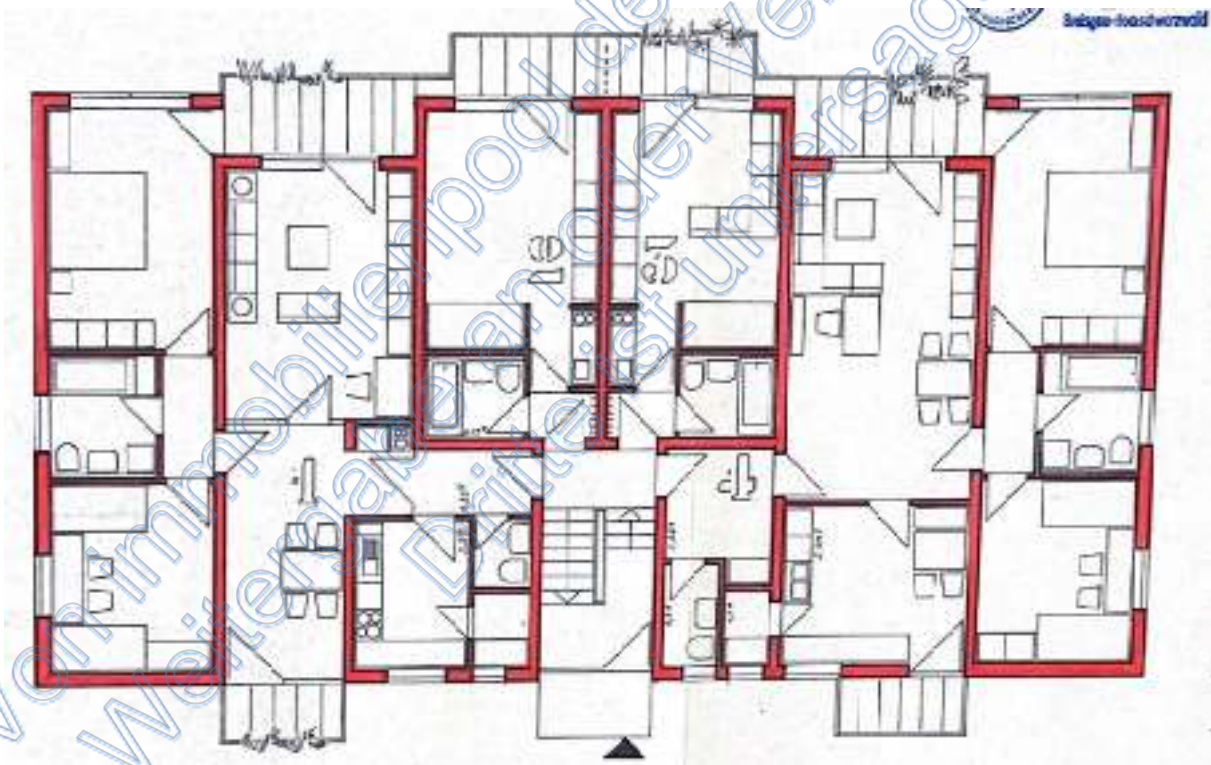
Gesamter Grundriss des Erdgeschosses
